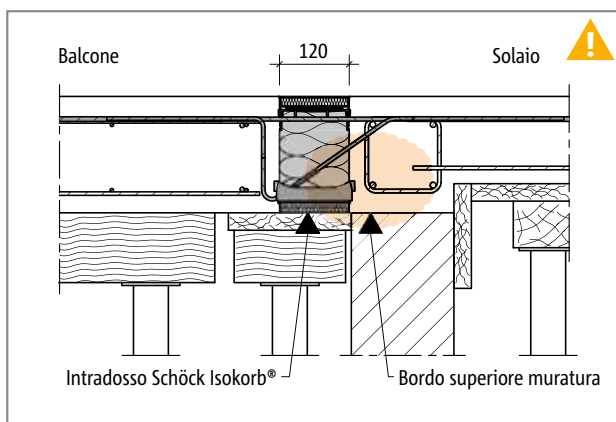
Schöck Isokorb® XT tipo KL: balcone in opera dotato di solaio con salto di quota su parete di muratura
